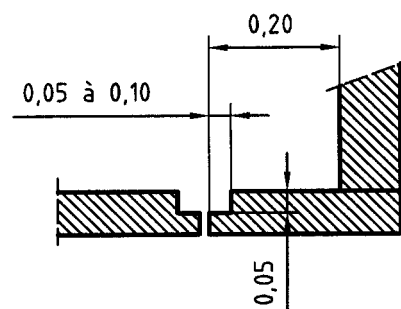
joint de paroi et de plancher : coupe verticale sur radier
